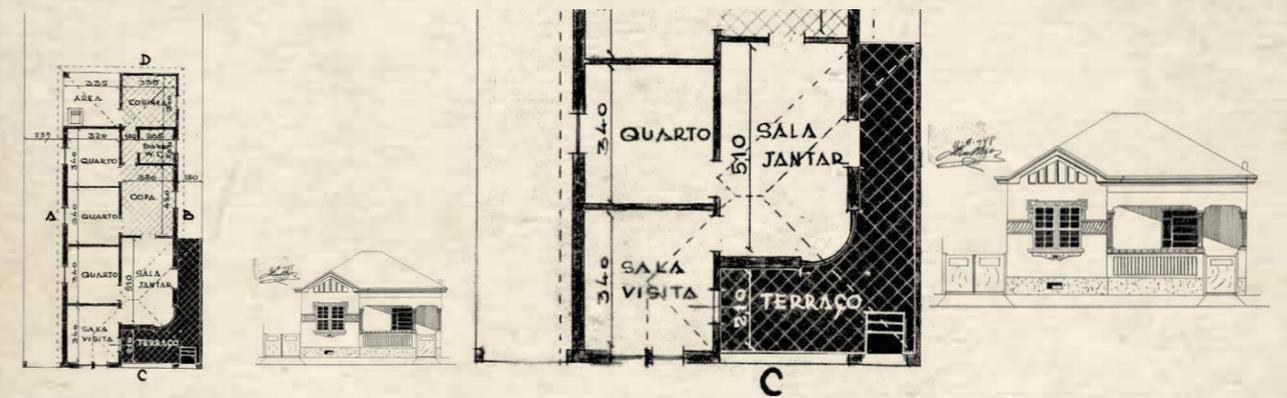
Planta arquitetônica e detalhe. Sala localizada na parte frontal da planta, dividindo com o terraço o espaço do alinhamento. Nota-se o destaque na composição formal da fachada, cuja abertura recebe parapeito e elementos decorativos. O terraço permite o acesso às duas salas, de visita (mais formal) e de jantar (mais íntima). PC 262/48. (APH-RC)
